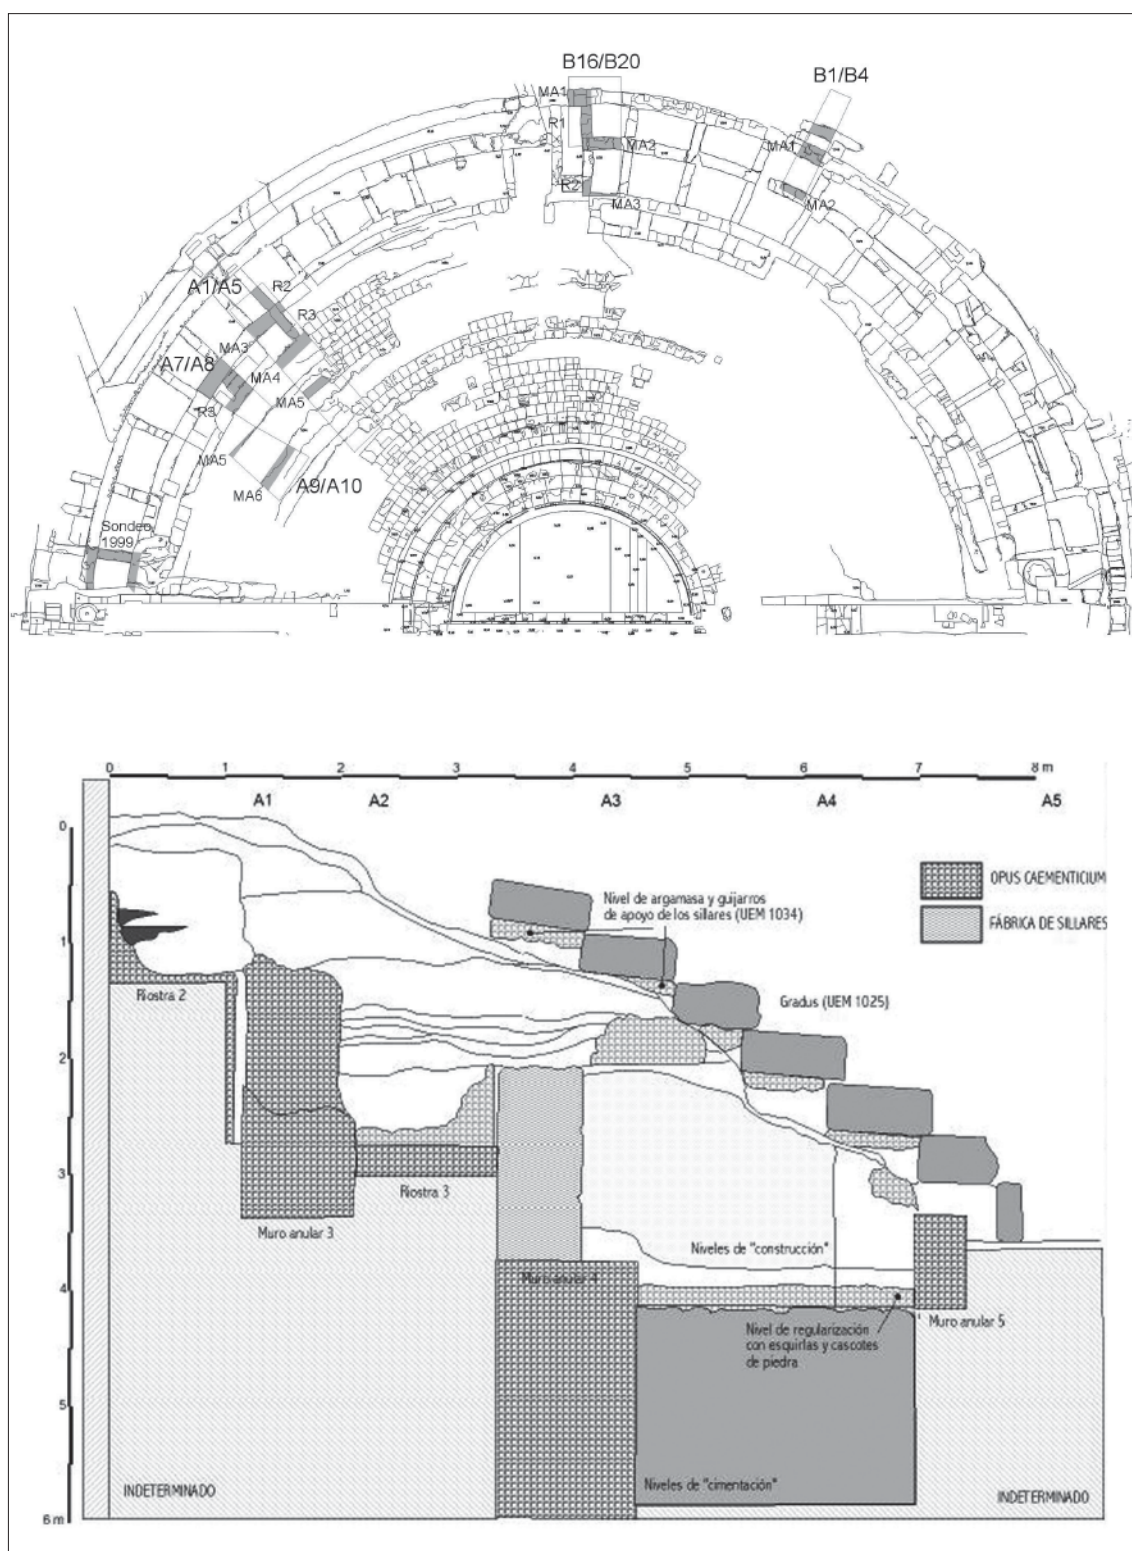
Planta y sección de la estructura de cimentación de la cavea.
